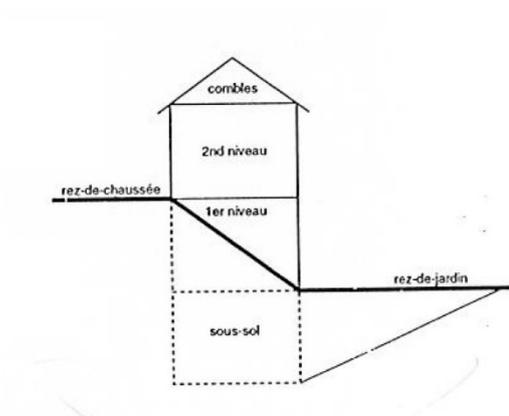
adaptation au terrain (croquis issu de la ZPPAUP)
